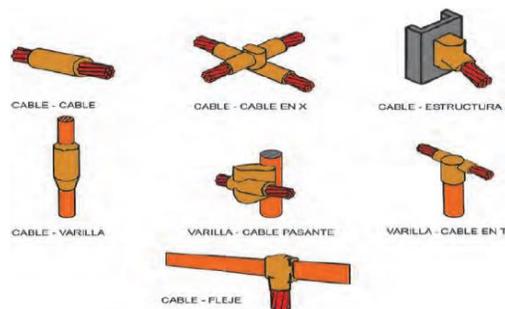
Tipos Soldadura Exotérmica
